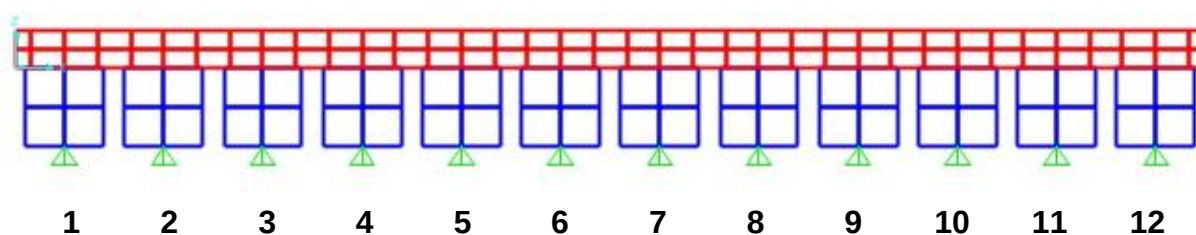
Vista frontal do tabuleiro de madeira-concreto e as translações dos nós dos apoios nas extremidades das vigas de madeira do modelo 3. Fonte: O autor.
